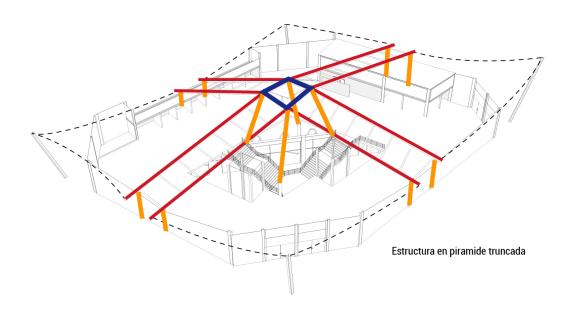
Esquema de sistema estructural del edificio del terminal Fuente: Autor
